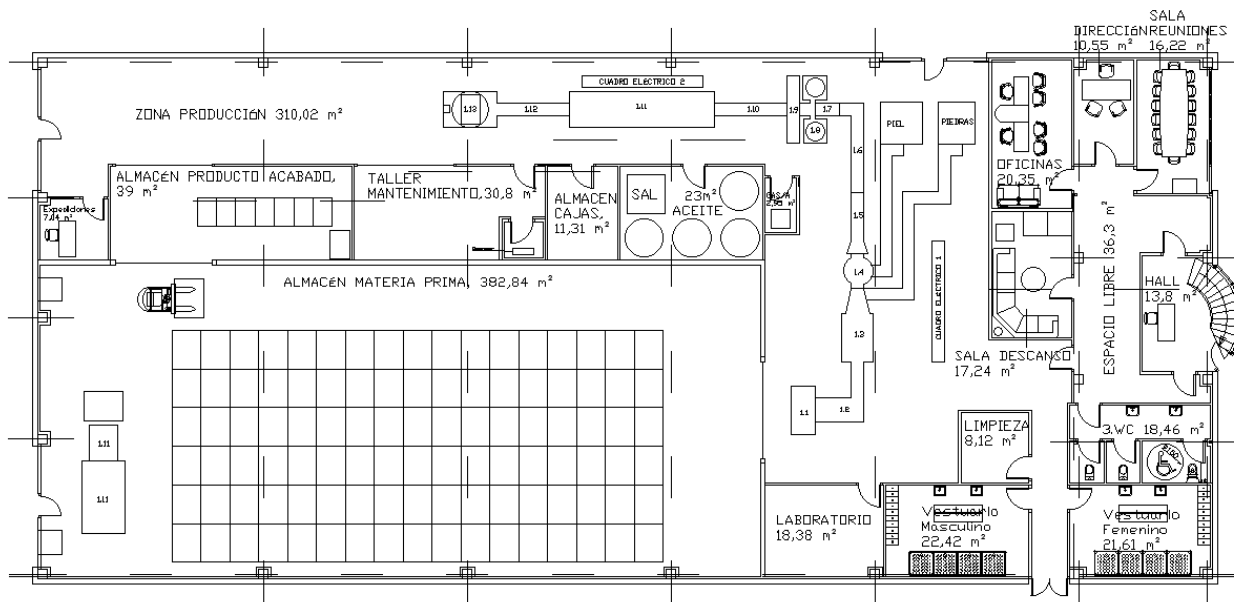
Vista distribución planta baja. Fuente: Proyectista
